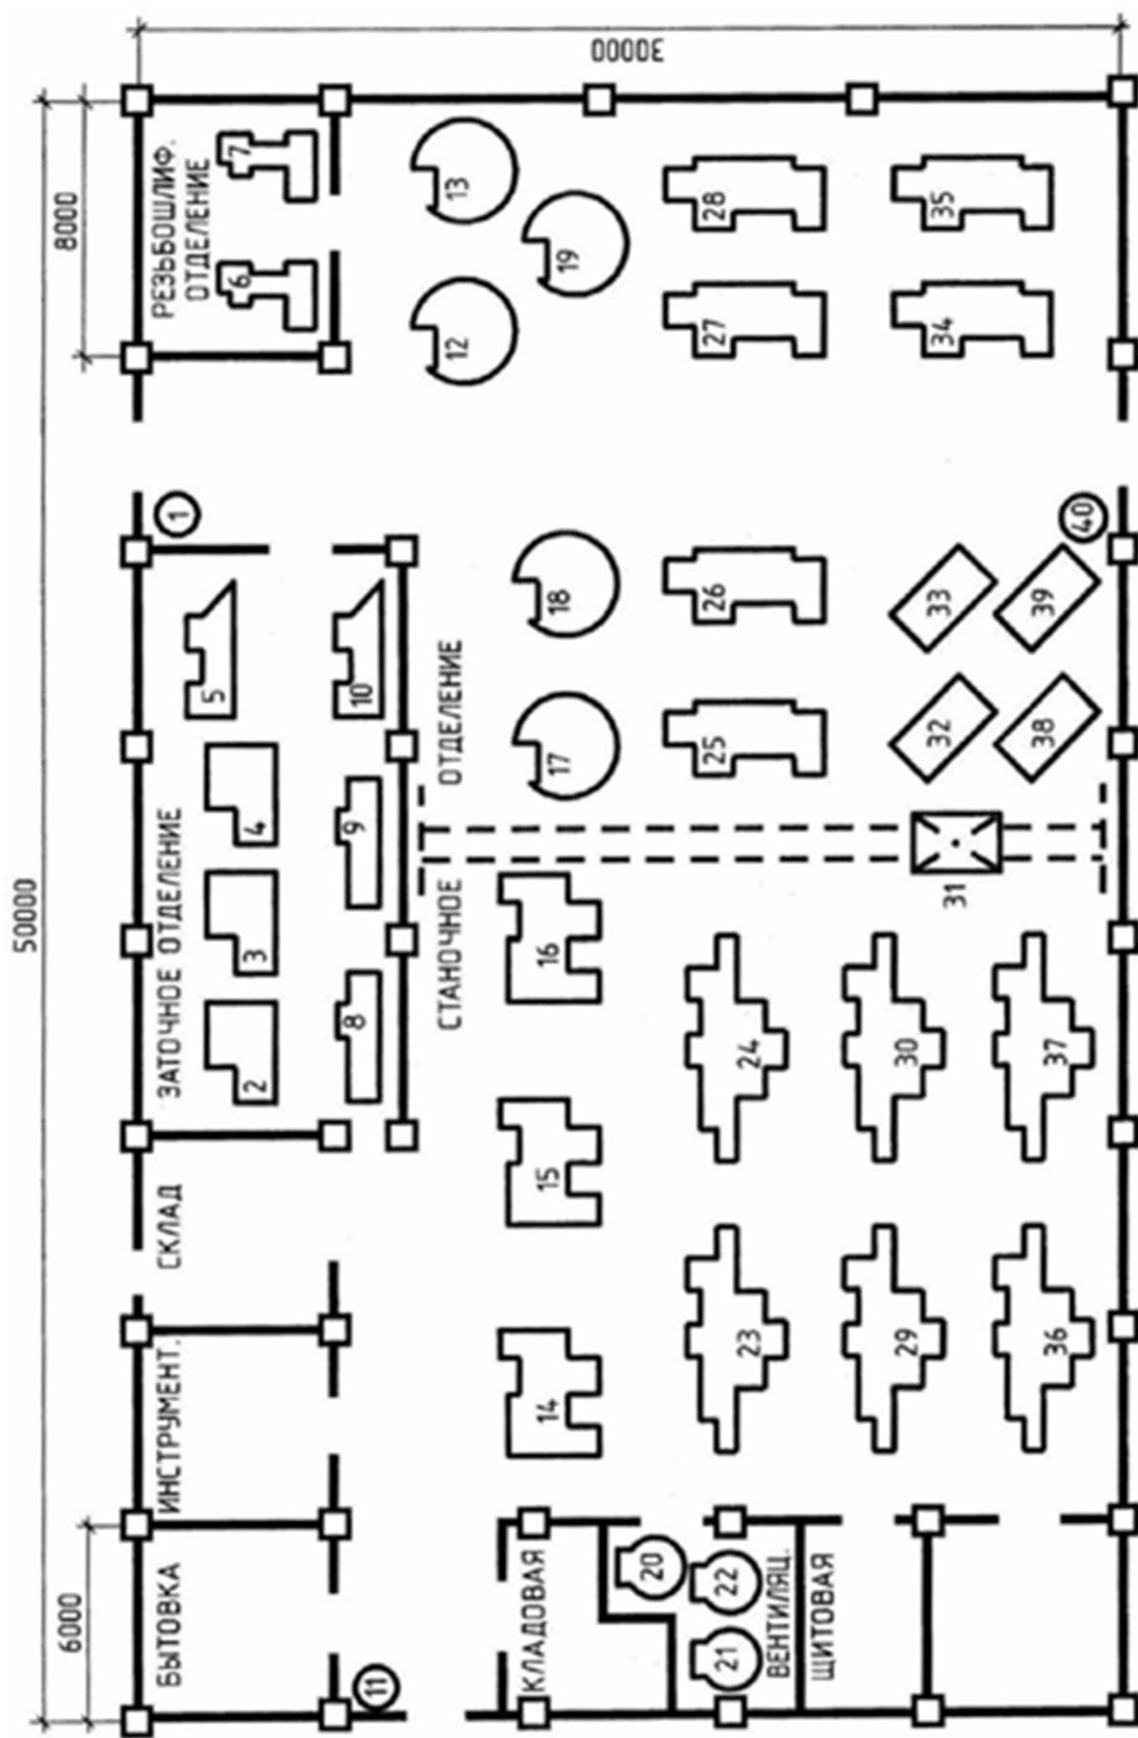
План расположения ЭО цеха металлообрабатывающих станков
